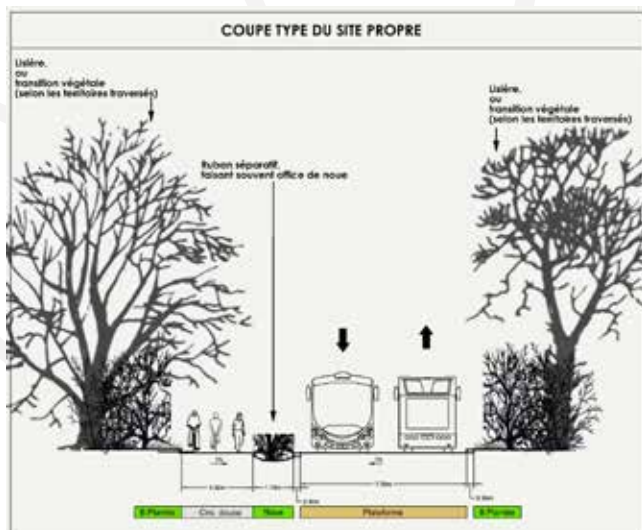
Coupe Type d'insertion du site Propre sur cavalier (Egis Villes et Transport et Pierre DUHAMEL)
